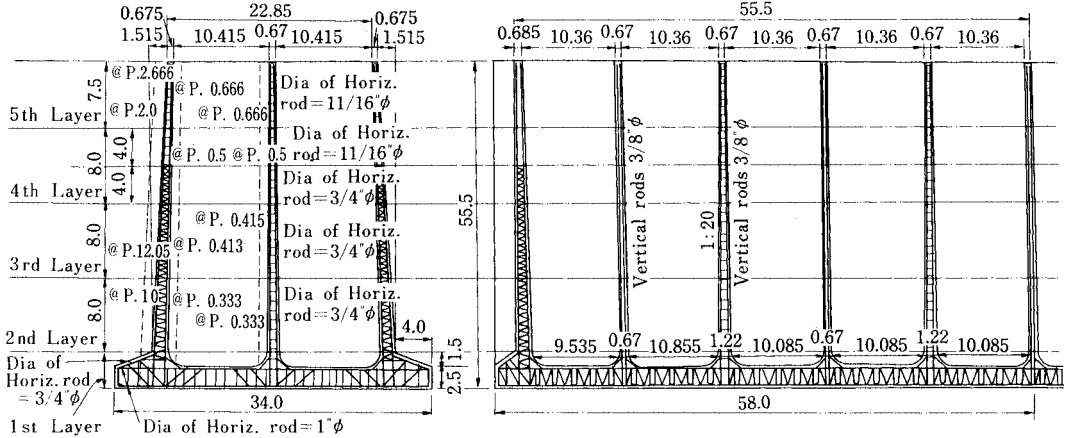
神戸港第1~4突堤に用いた鉄筋コンクリートケーソンの断面図 (単位: 尺)
